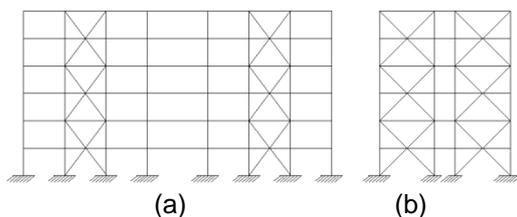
Denah Penempatan Tipe Bresing X-1 dan X-2
